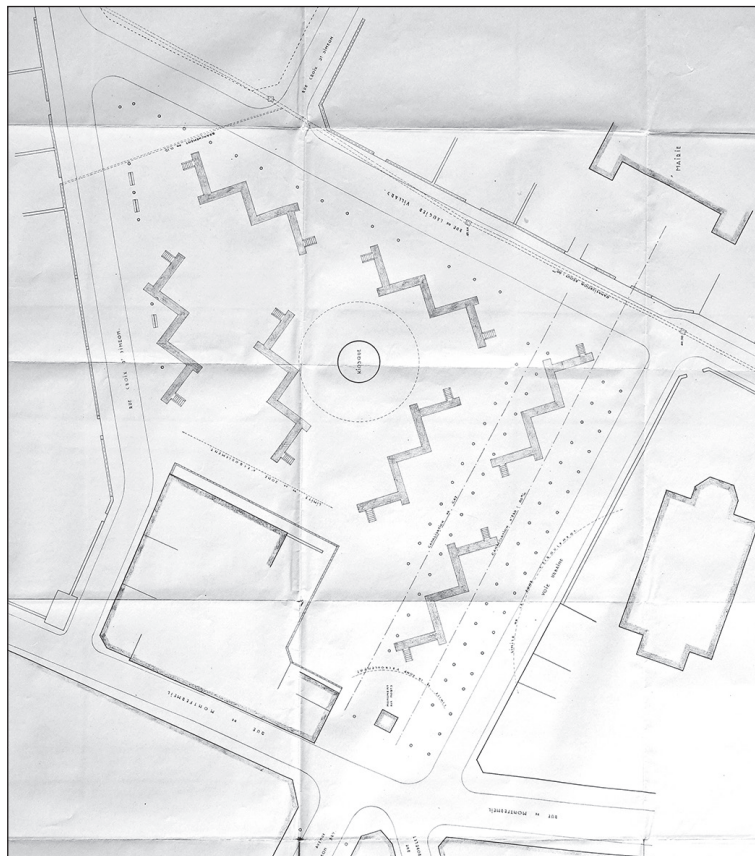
Plan général des tranchées de la place Foch à Gagny, Arch. mun. Gagny, boîte 1.
